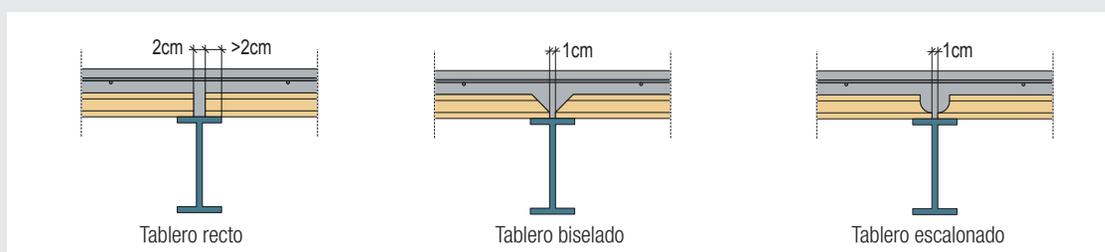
Apoyo del tablero en cubierta sobre viguetas autoportantes para hormigonado de la losa
